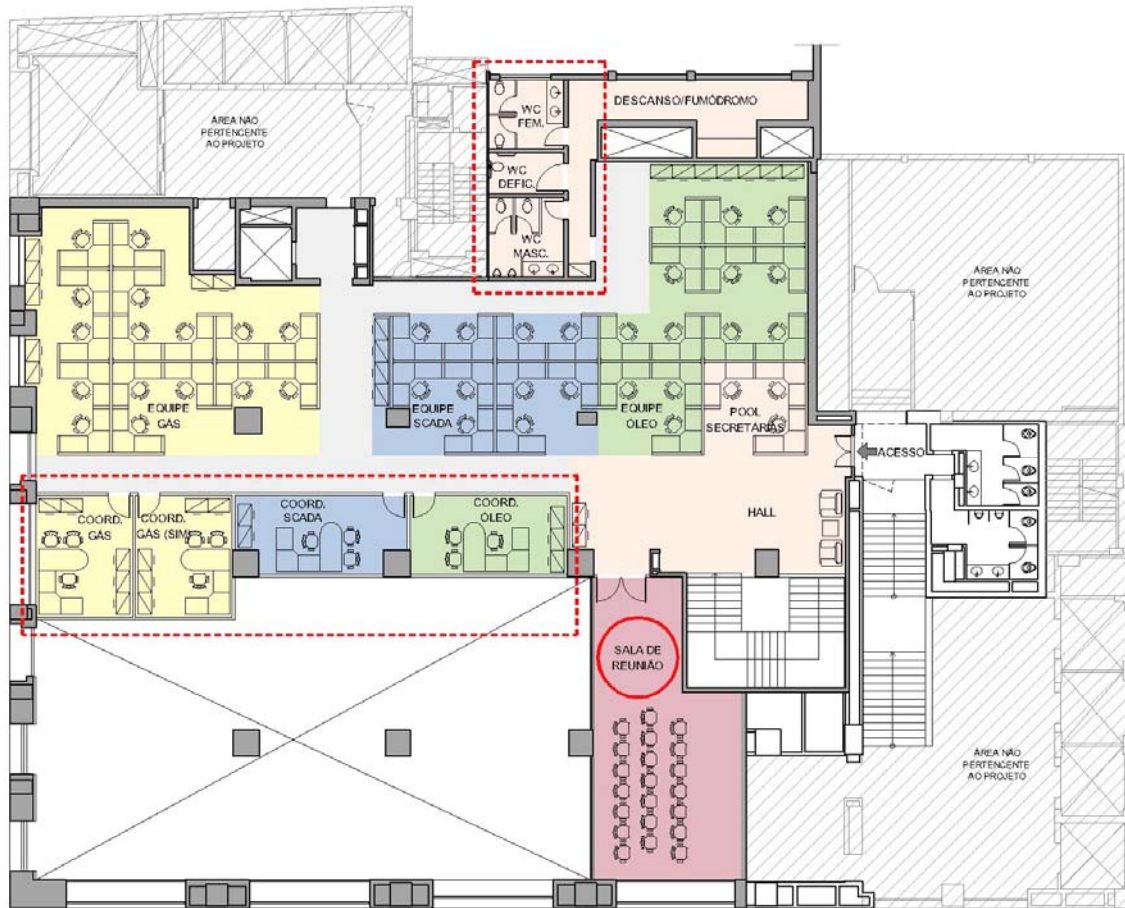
Planta baixa mezanino: opção 1 para o layout (oito de junho)
